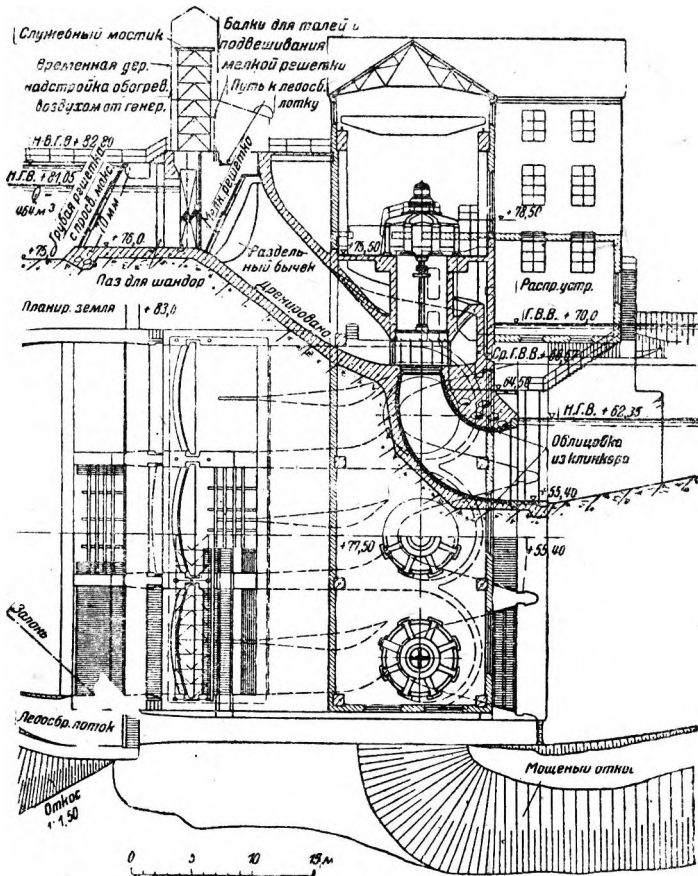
Норрфорсен. Плотина и силовое здание. Фасад и план.
